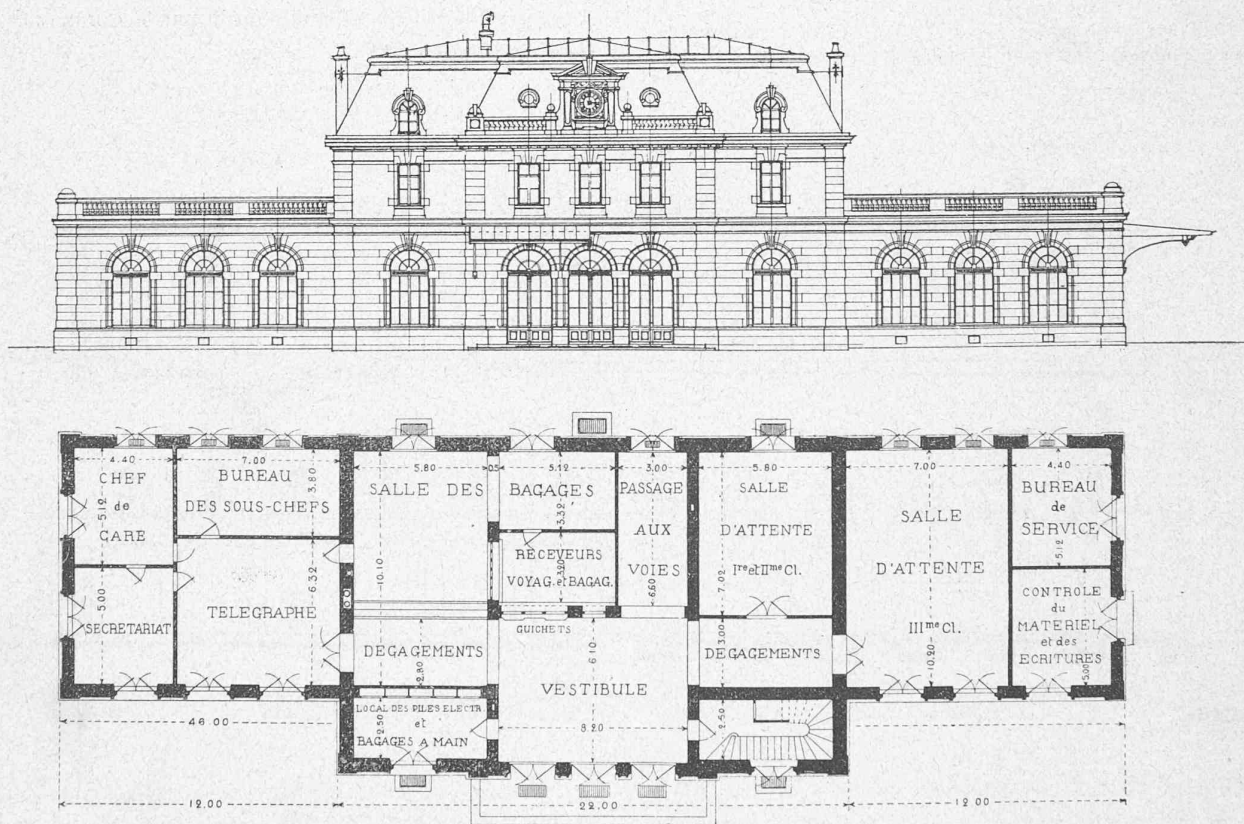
et 3. — Gare de Renens. — Façade sur cour et plan du futur bâtiment aux voyageurs. — Echelle 1:300.
